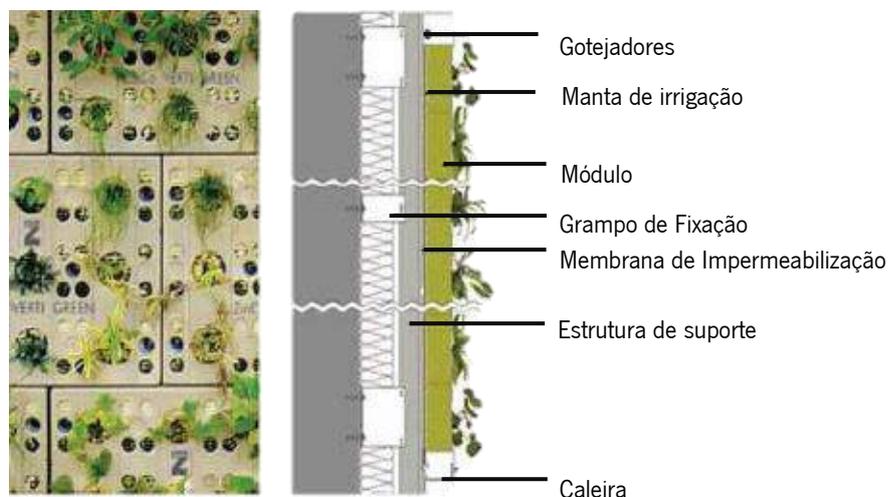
Pormenor Construtivo de Fachada Verde Modular
